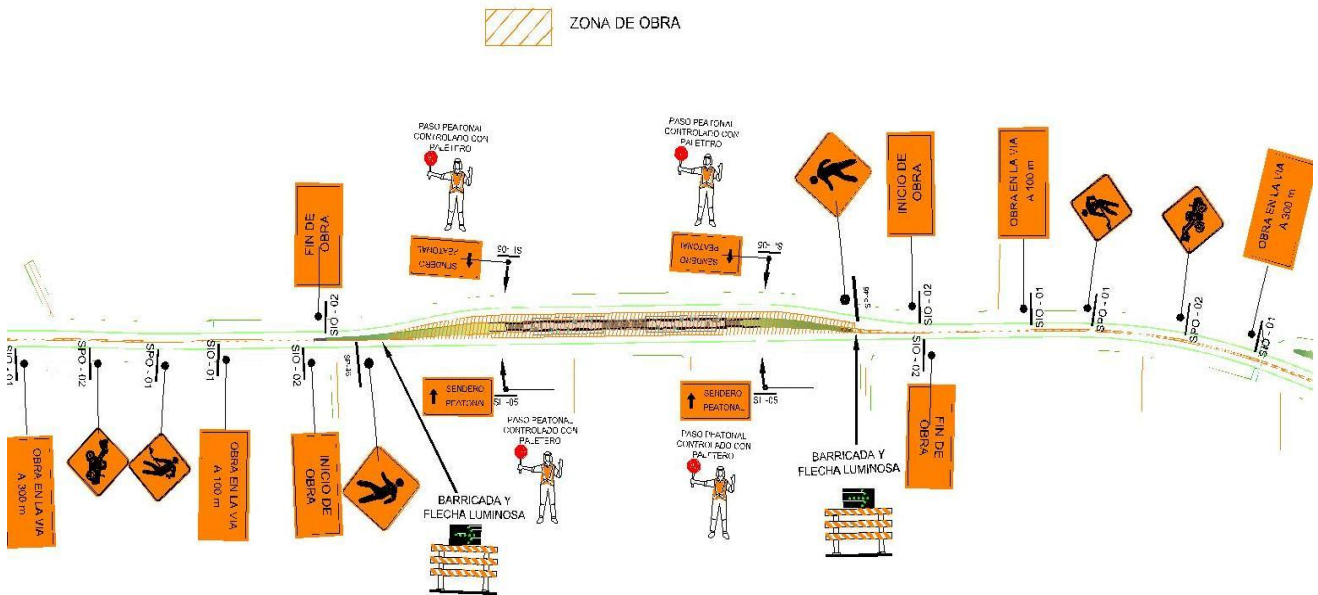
Plan de Manejo de Tránsito para Posibles Estaciones de Parada a construir
